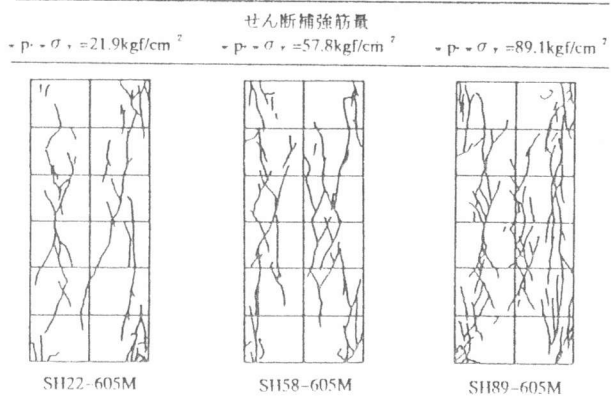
(a) 最大せん断耐力時までのひび割れ発生状況
